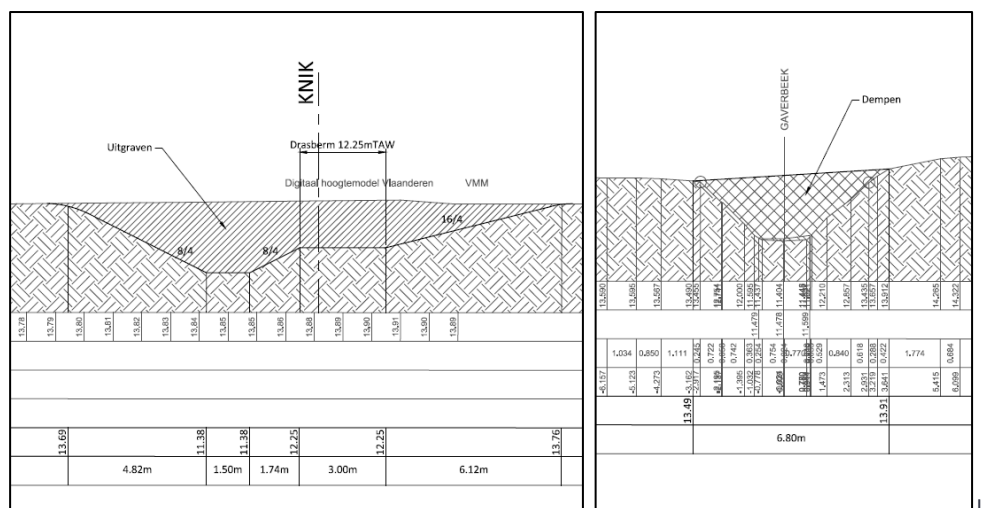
Plan met aanduiding van de hermeandering van de Gaverbeek (bron: opdrachtgever)
